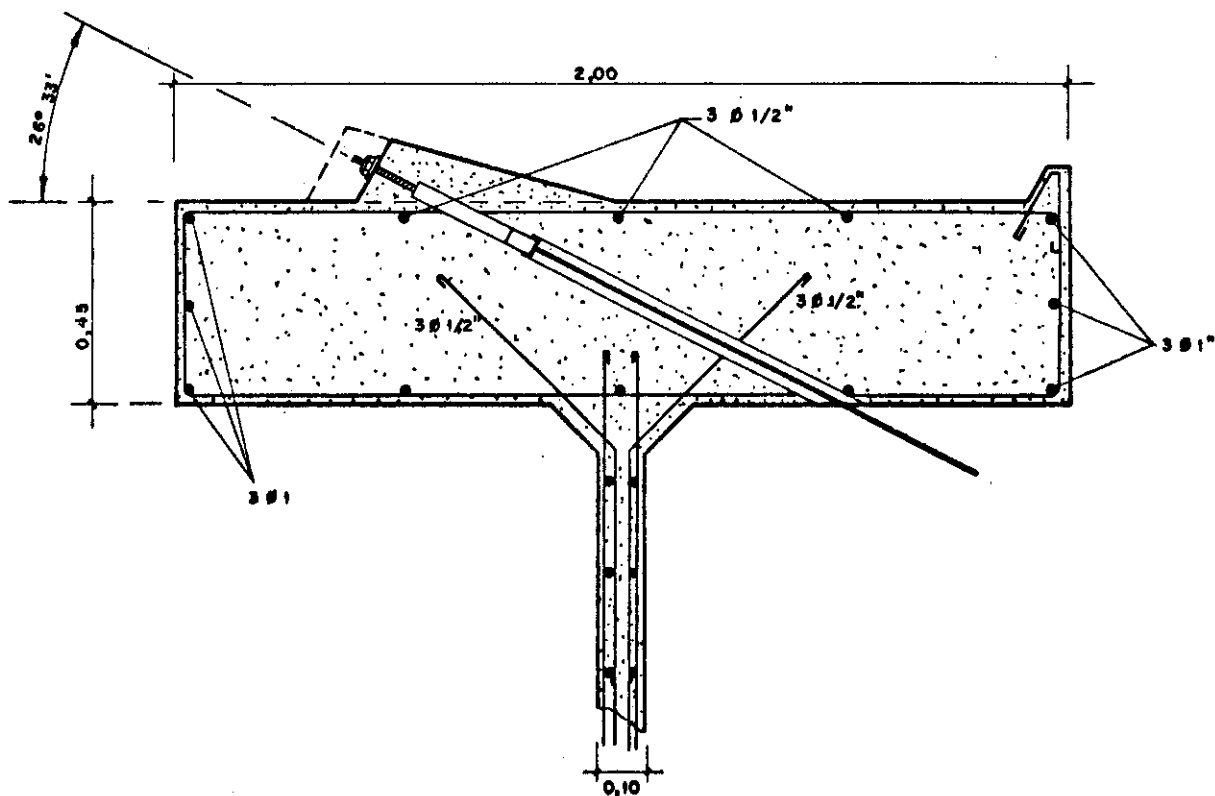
Secção transversal do anel externo (med. em m)
